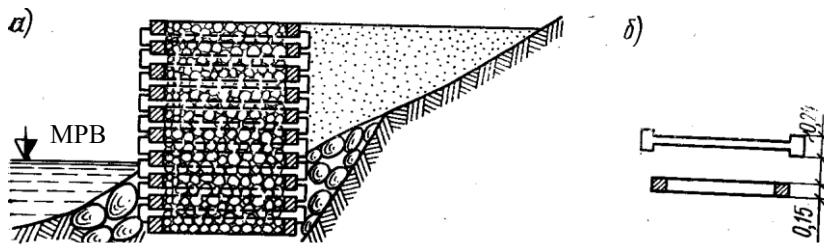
Укріплення берега залізобетонними ряжами: а – поперечний профіль; б – переріз елементів
